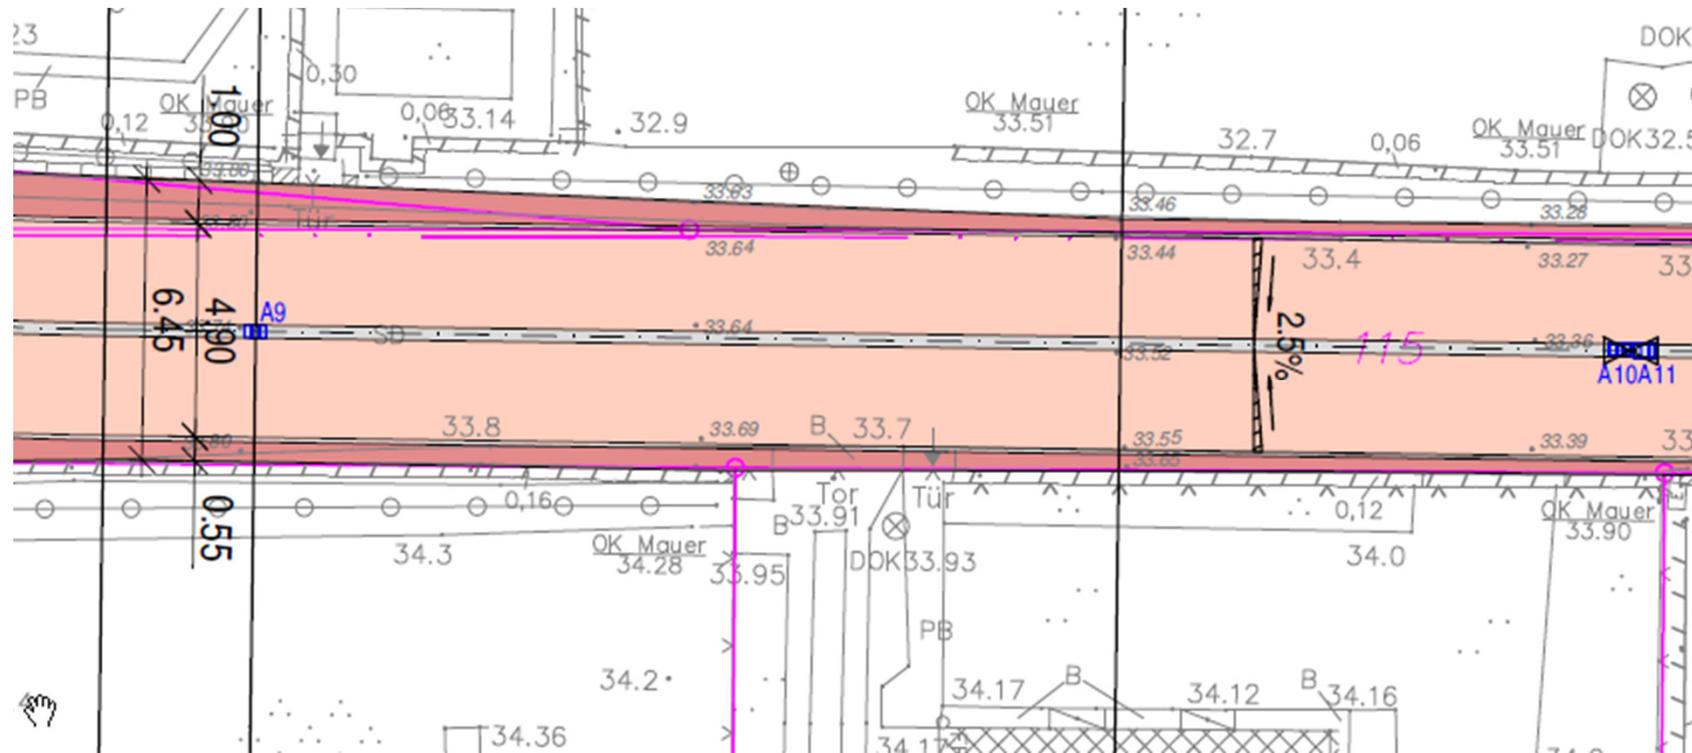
Lageplanausschnitt Vorzugsvariante mit 4,90 m Fahrbahnbreite
